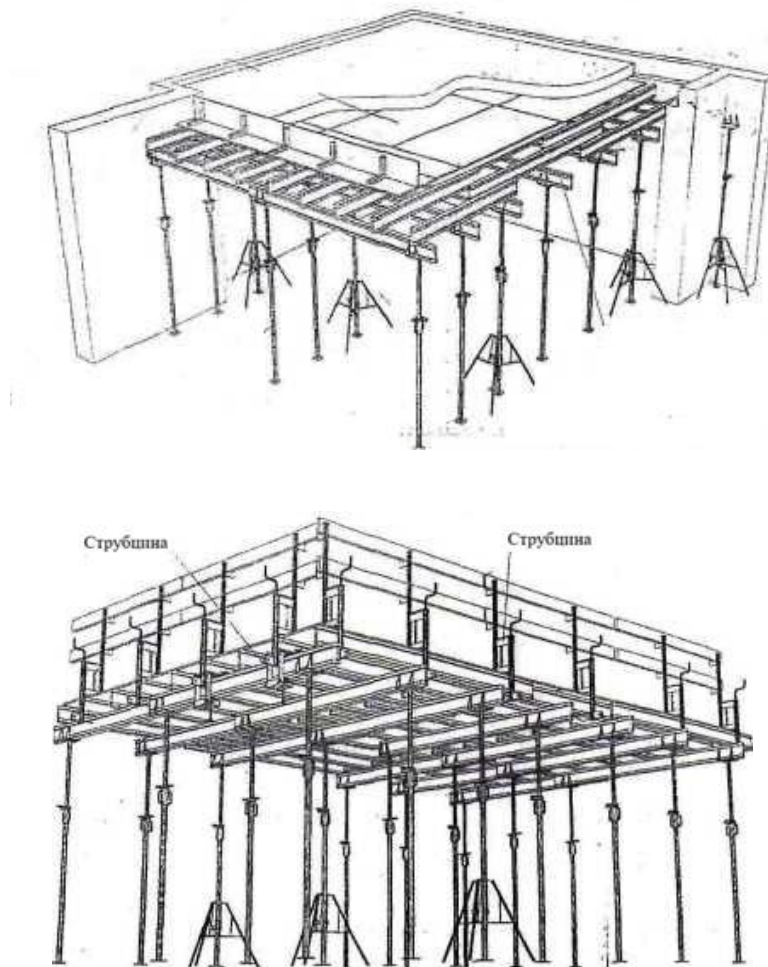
Схеми опалубочних рішень для бетонування перекриття
